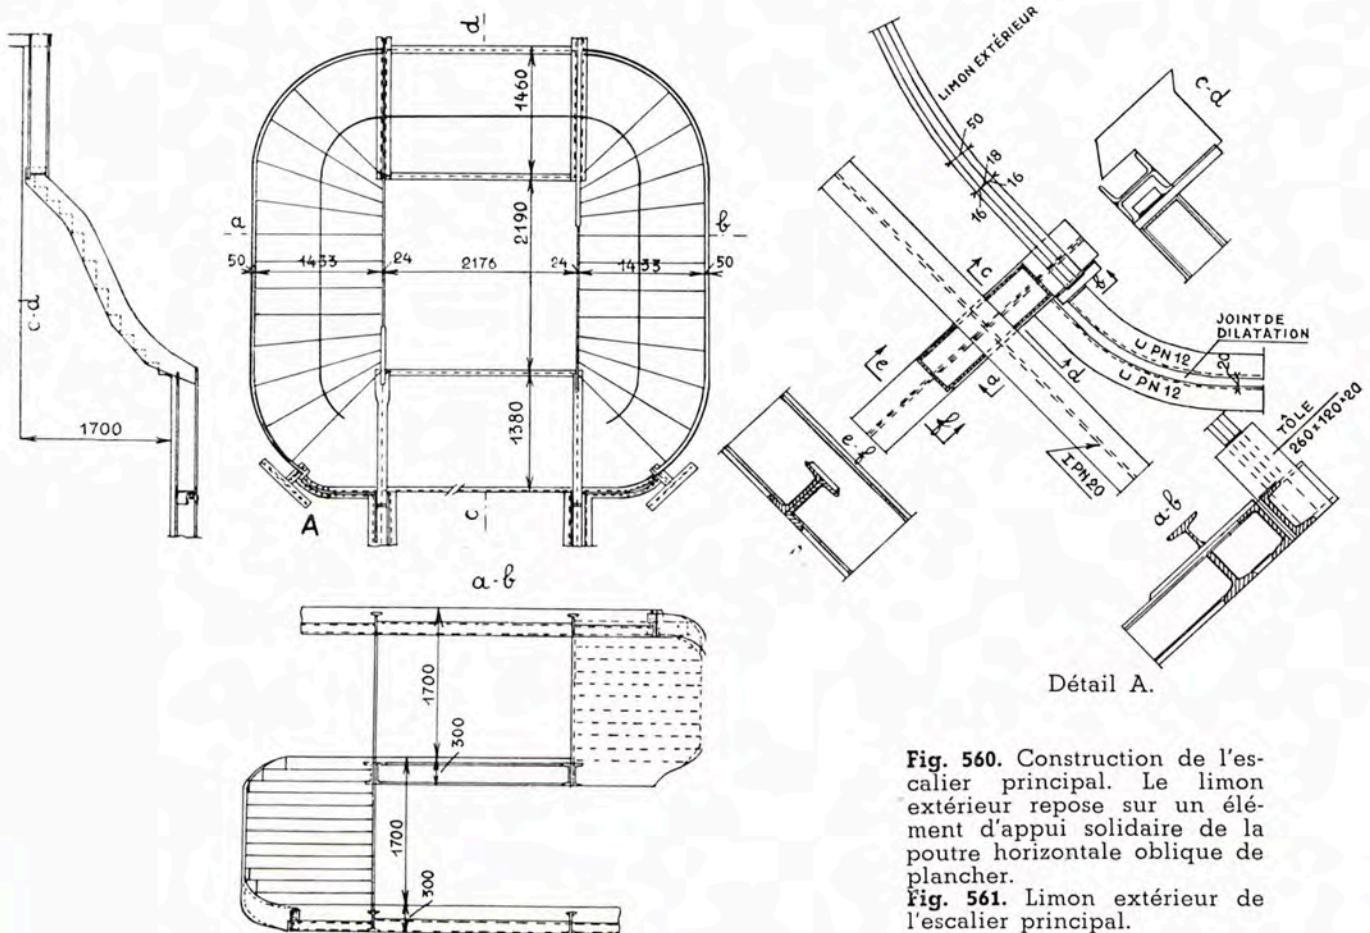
Construction de l'escalier principal. Le limon extérieur repose sur un élément d'appui solidaire de la poutre horizontale oblique de plancher.
